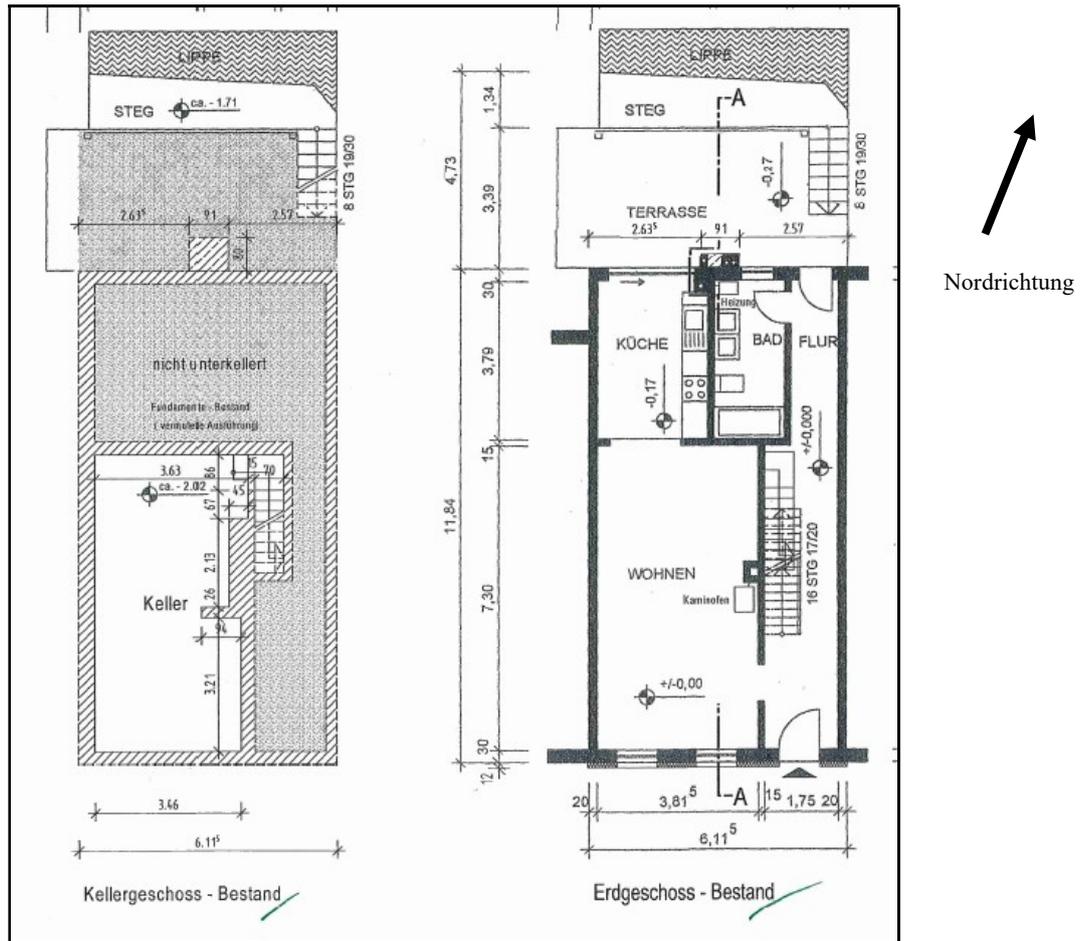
Grundrissübersicht zum Keller- und Erdgeschoss (ohne Maßstab, Quelle: Bauakte der Stadt Lippstadt, Nr. 437/11)
